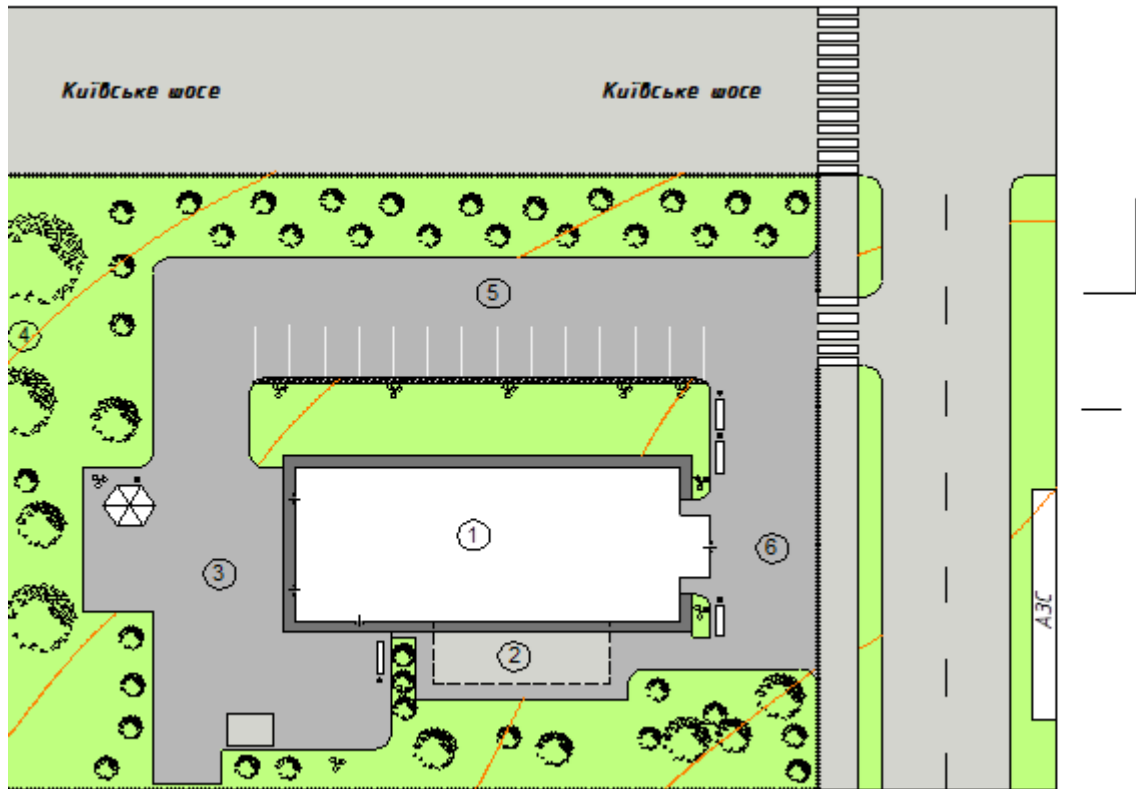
Генеральний план будівлі кафе на 75 місць.
